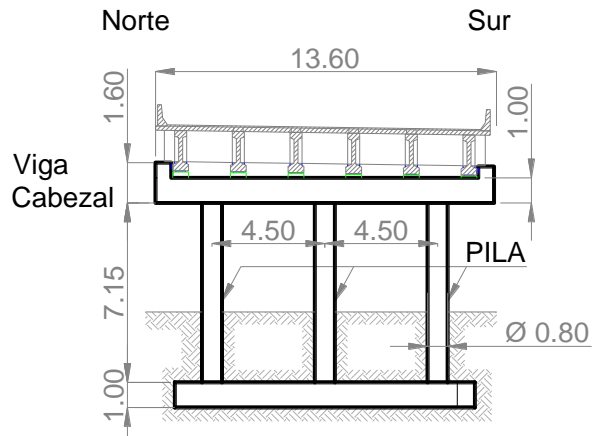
Sección transversal del puente de calle Paso. Dimensiones en metros.
